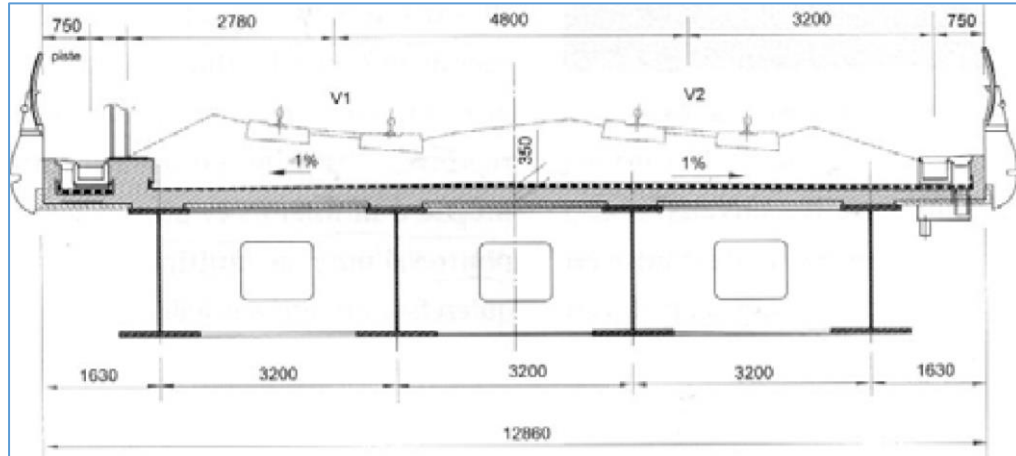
Ejemplo tablero metálico con losa de concreto superior (multijacena)
